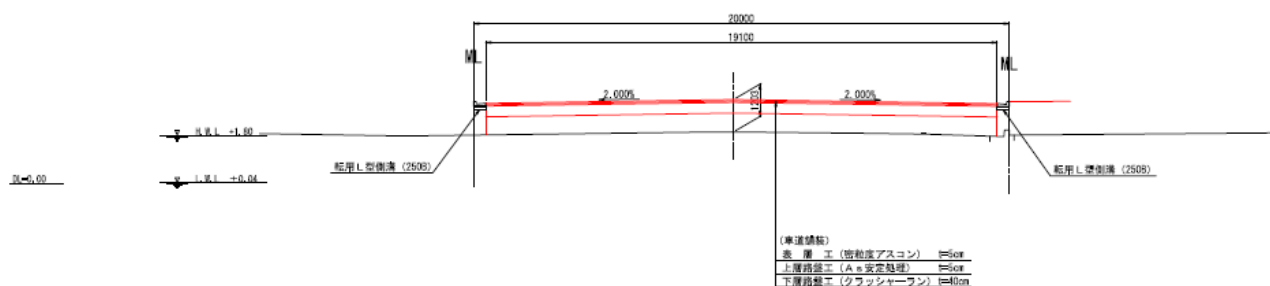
No.4 埠頭西 3 号線標準横断面図（復旧後）
